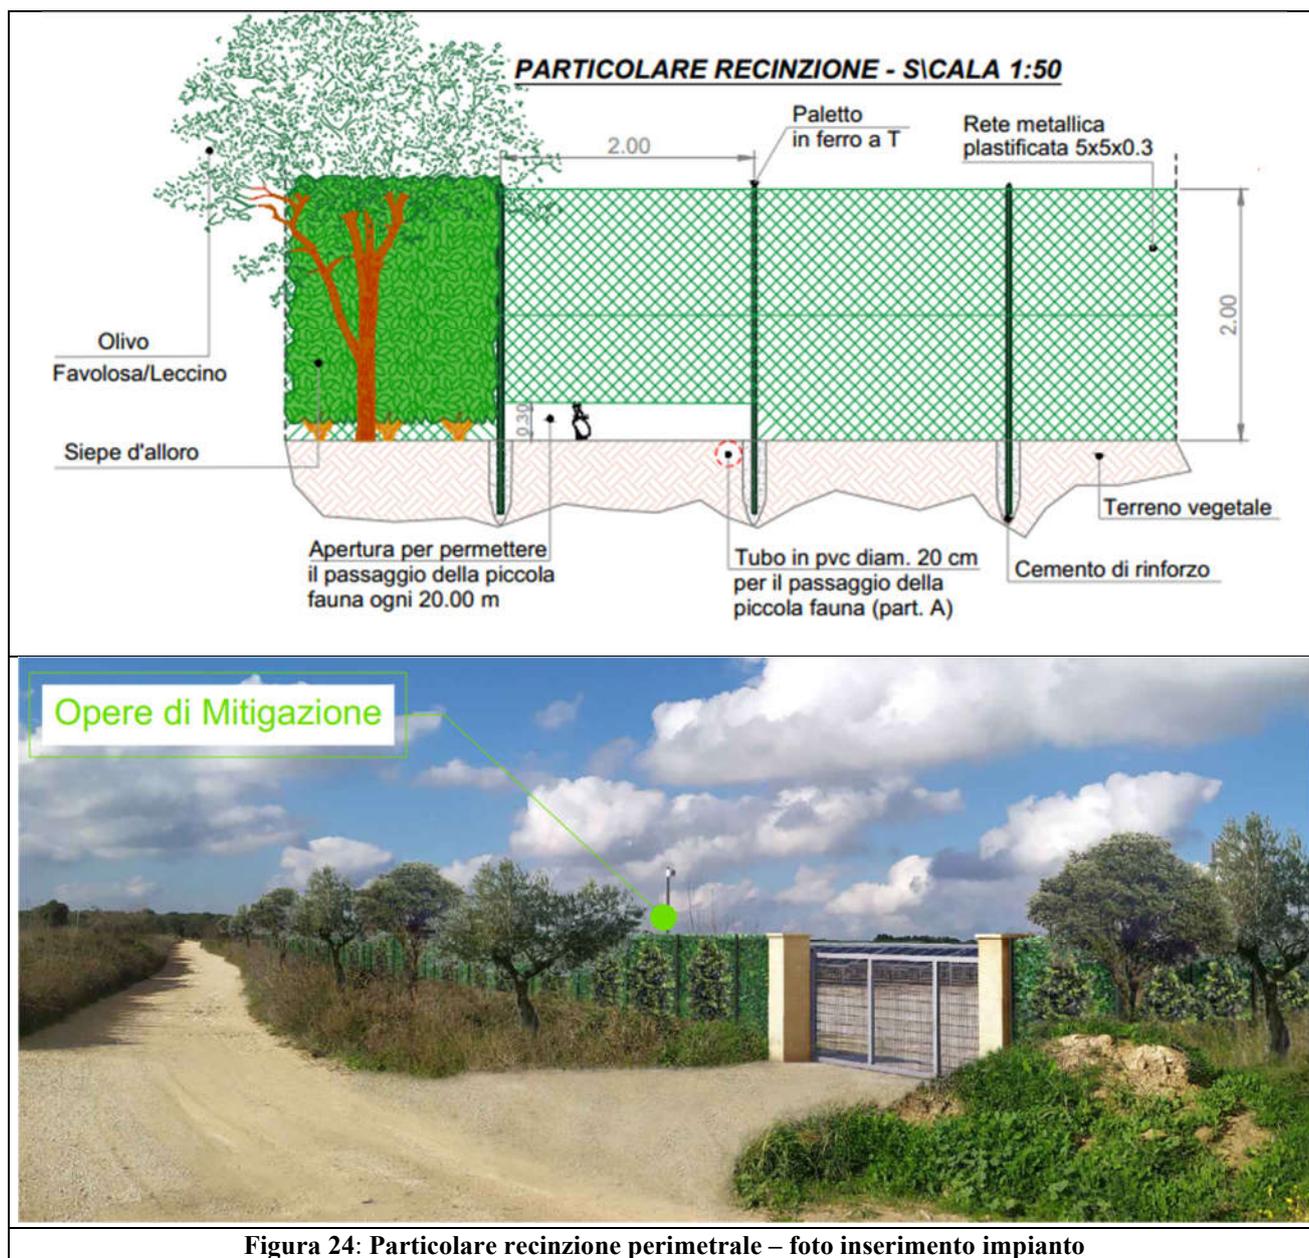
Particolare recinzione perimetrale – foto inserimento impianto
